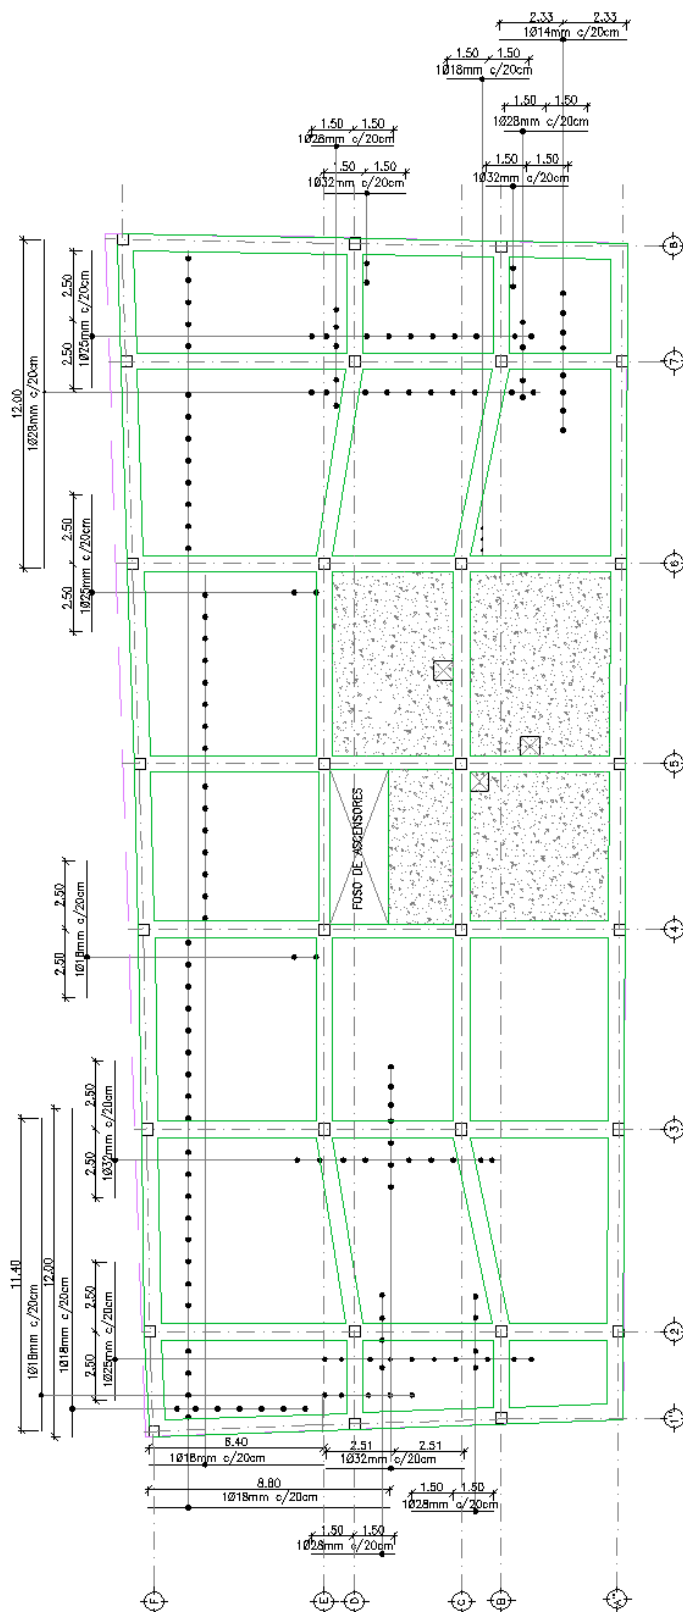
Refuerzos adicionales de losa cimentación Nv - 4.08
